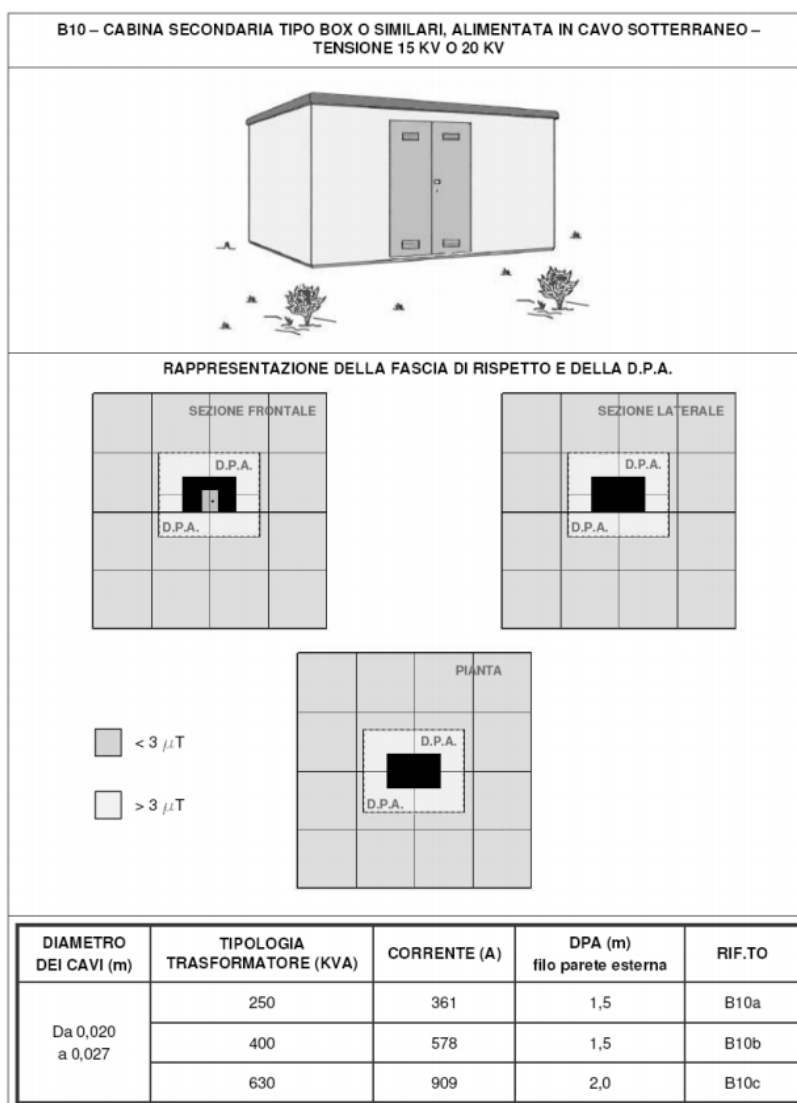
Fasce di rispetto cabina secondaria – Enel distribuzione
